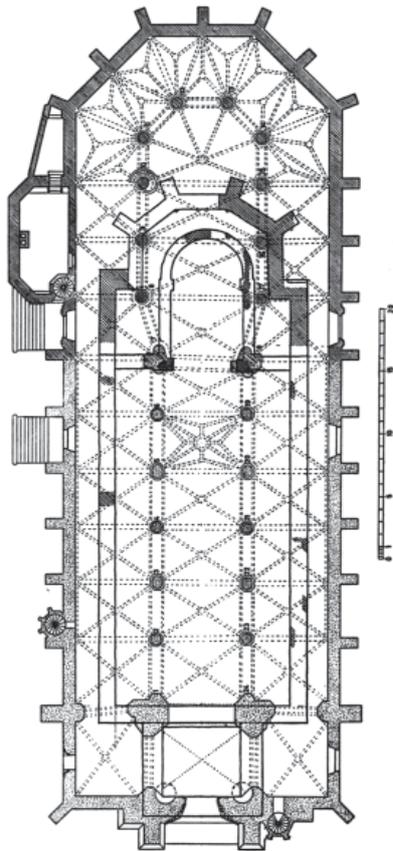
Grundriss der Heiliggeistkirche mit Eintragung der Fundamente der Vorgängerbauten, Abb. aus Zahn 1960.
